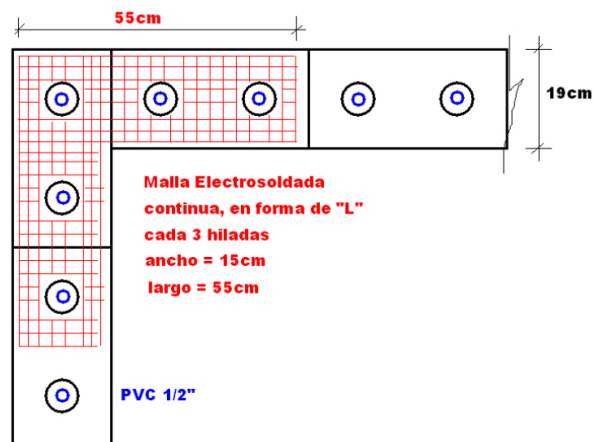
Muro reforzado usando tubos PVC, encuentro en esquinas
